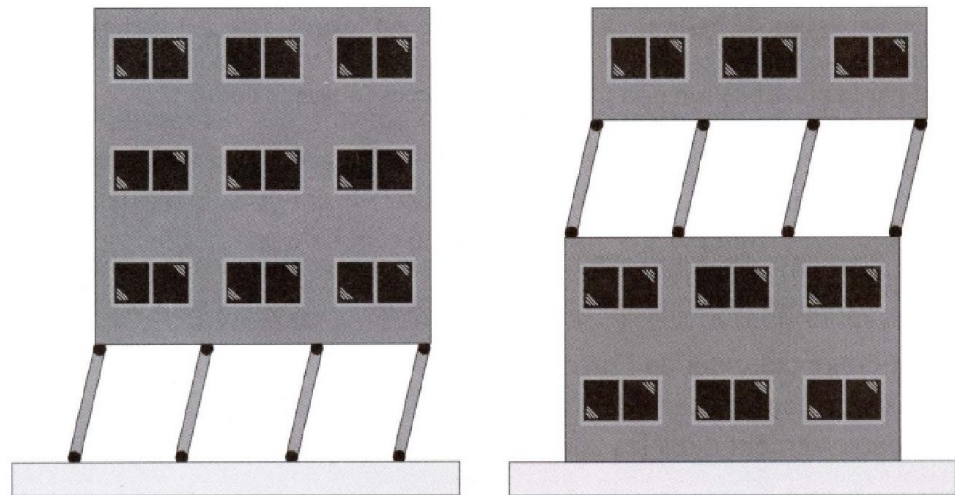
Rupture des poteaux d'un niveau « souple ».
